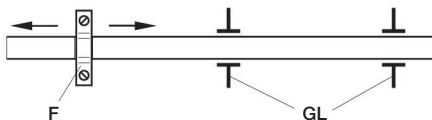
Befestigung durchgehender Rohrleitungen mit nur einem Fixpunkt
